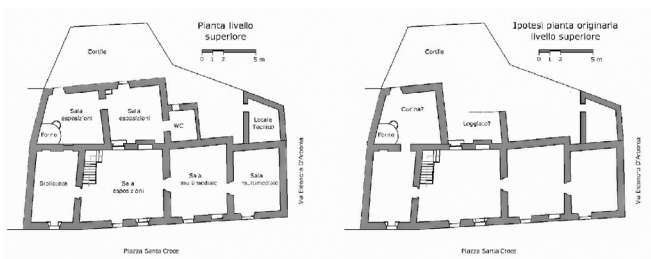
Stato attuale e ipotesi distribuzione planimetrica originaria.
